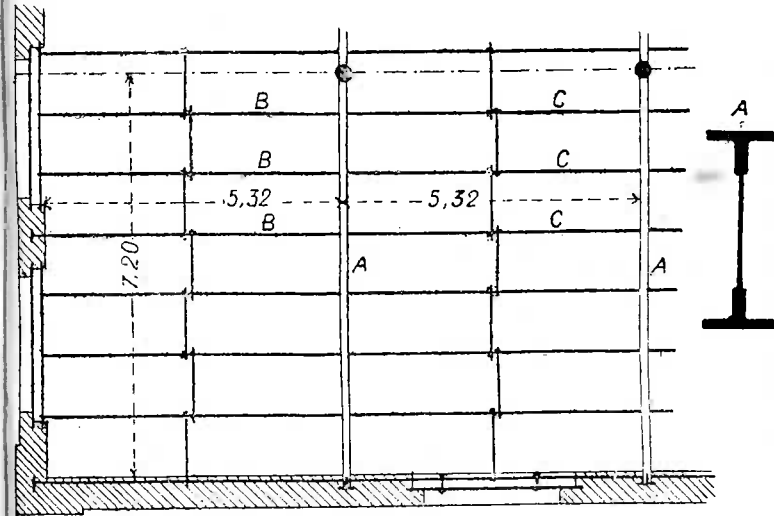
Fers d'un plancher. — Salle de métiers à filer
